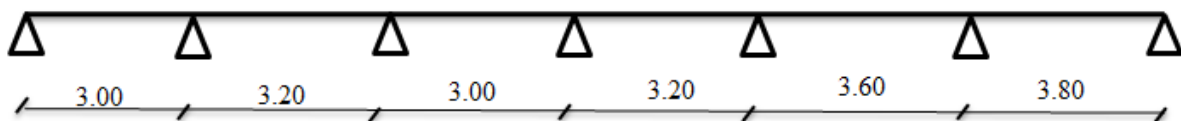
Poutrelle type 03 (Plancher terrasse inaccessible)
